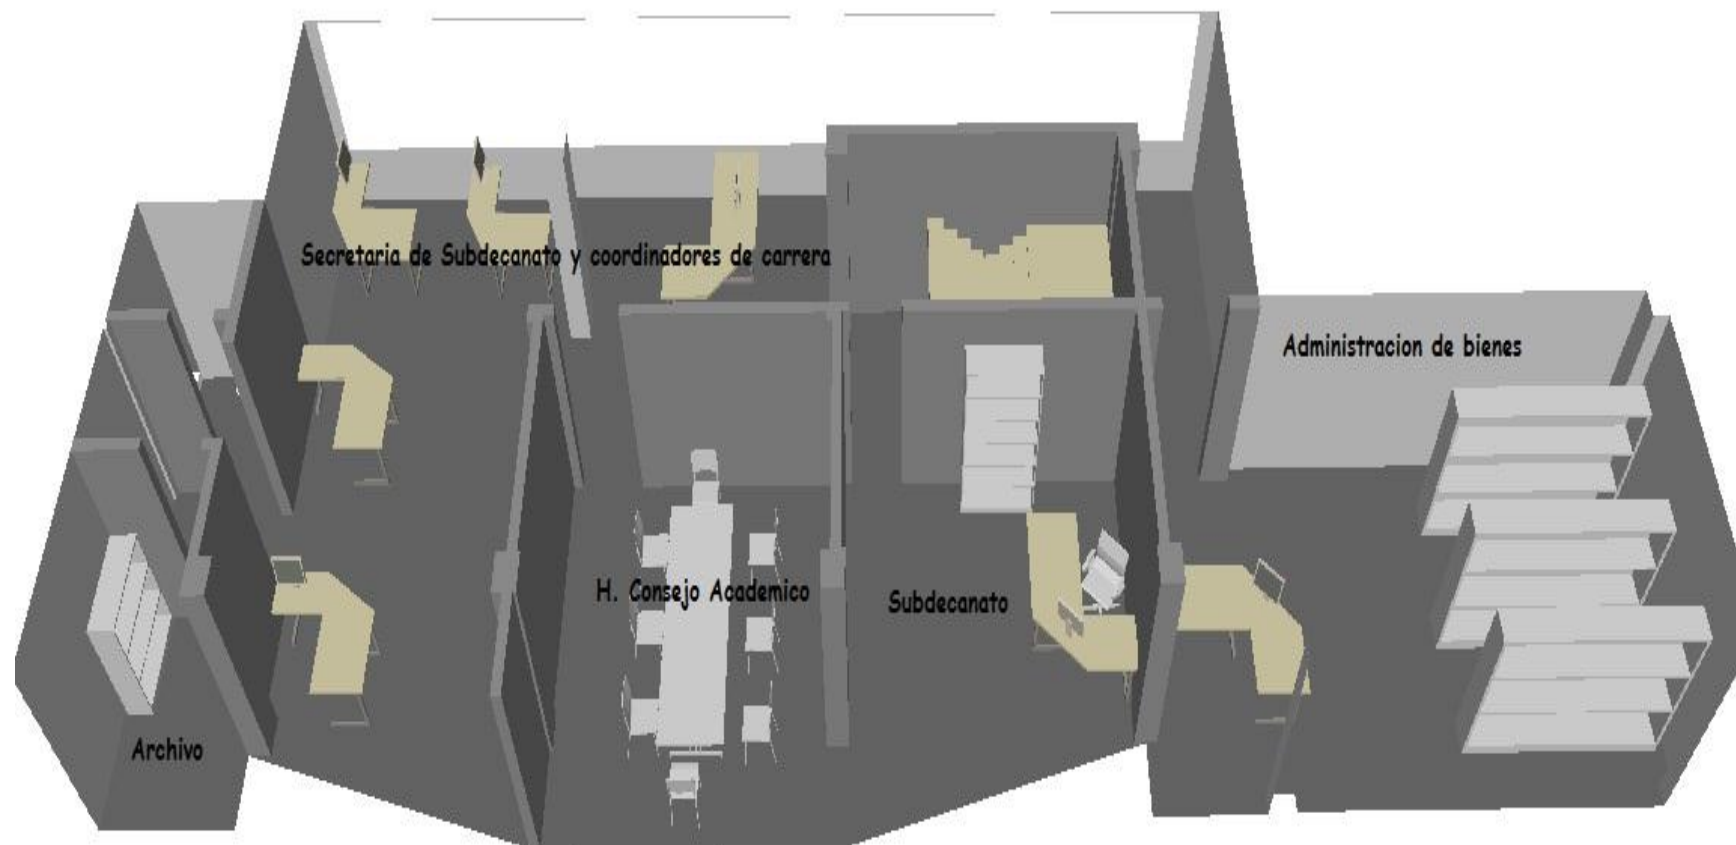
Plano tipo X Distribución de las oficinas segunda piso
